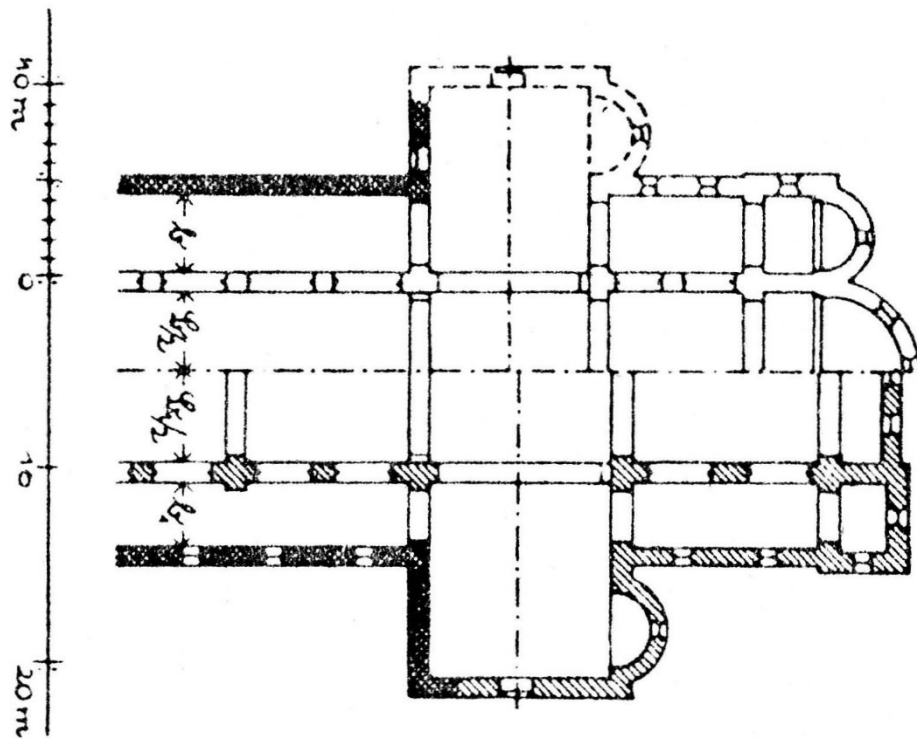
Erfurt, Peterskirche, schematischer Grundrissvergleich des 1. und 2. Presbyteriumentwurfes, nach Becker (Ausschnitt aus Abb. 19)
